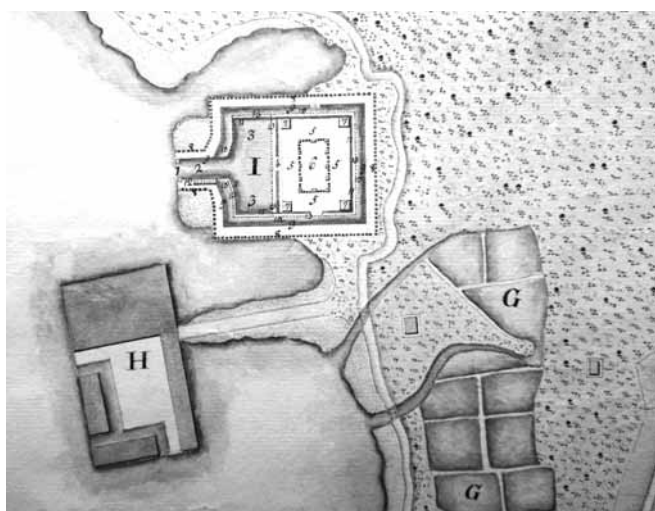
Anonimo, pianta di un nuovo lazaretto per infetti, inserita in una planimetria generale dell'area settentrionale della penisola di San Raineri, disegno acquerellato, prima metà del secolo XVIII (collezione privata).
